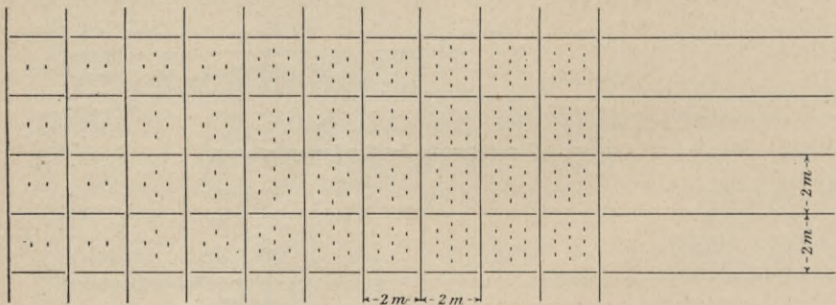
Grundriss der fertigen Vordüne.
